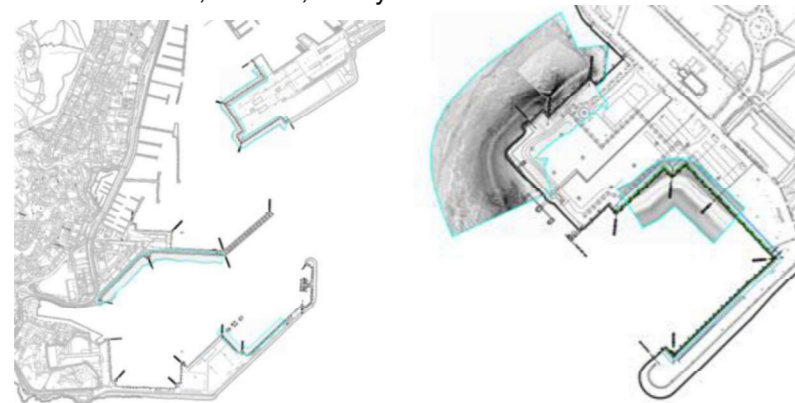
Zonas (enmarcadas en Azul) en planta de Puerto de Palma y Alcudia sujetas a inspección de Sónar de Barrido Lateral.
